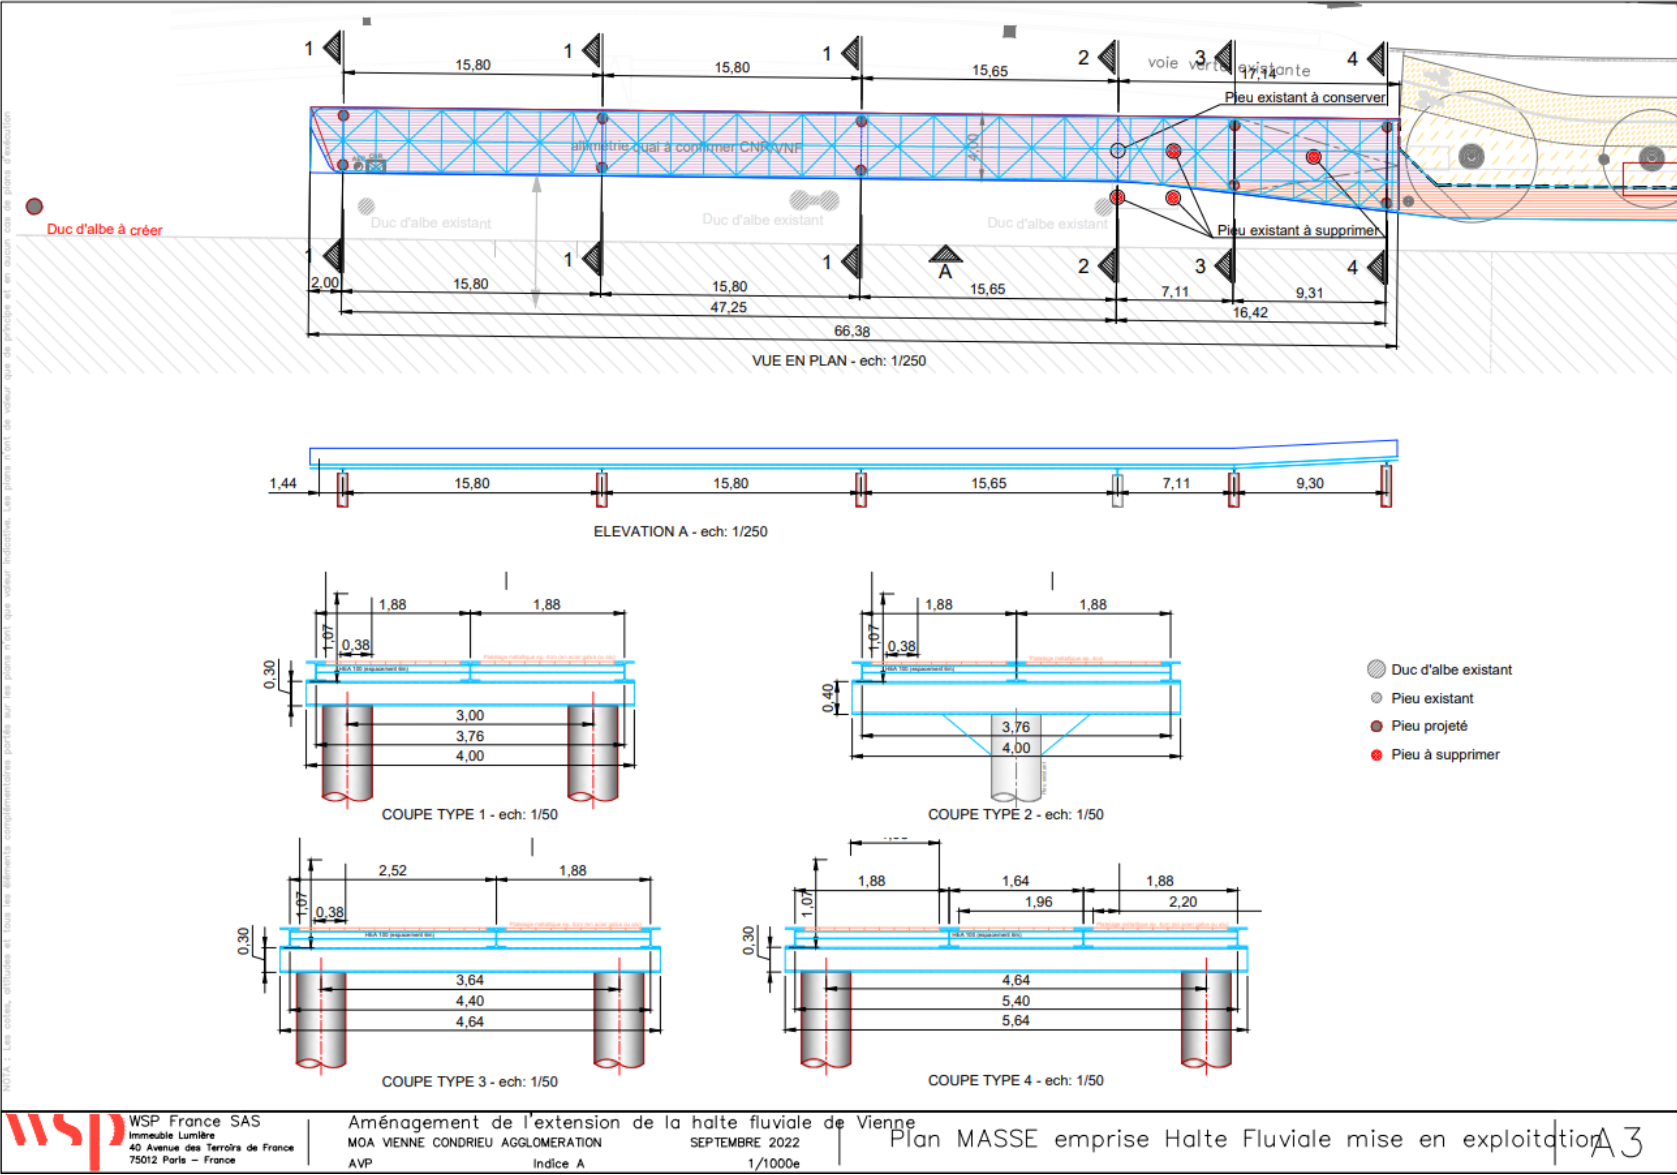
Plan masse et coupes emprise halte fluviale (1)
